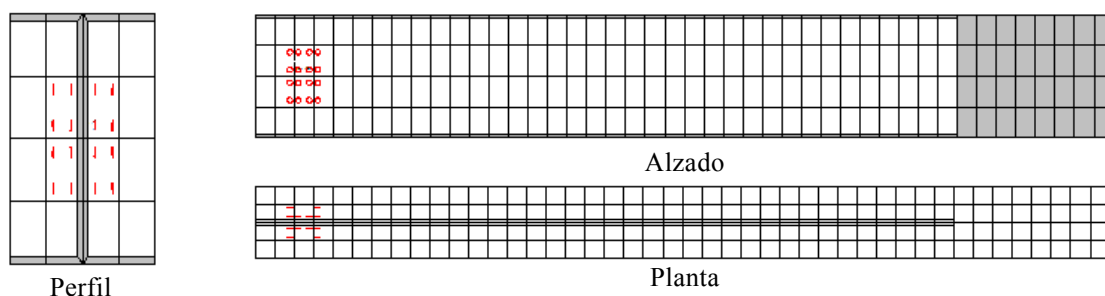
Fisuración del hormigón en la probeta con adherencia natural en el escalón de carga 31 [kN]
